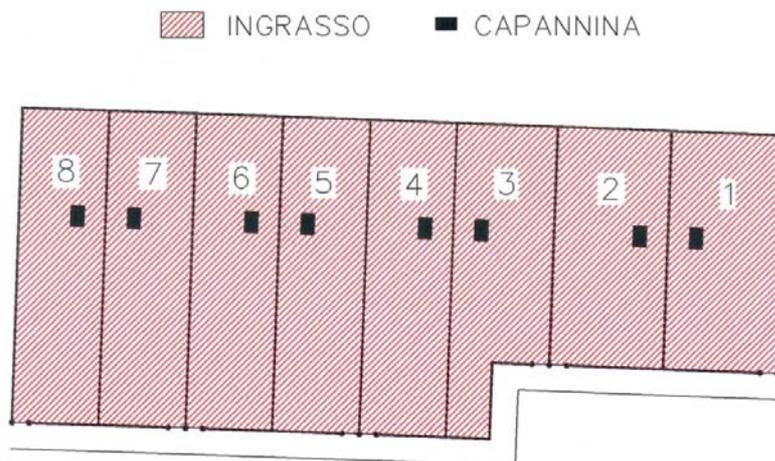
Planimetria dell'allevamento pilota 3) da ingrasso per 96 capi (azienda Fabiano)
